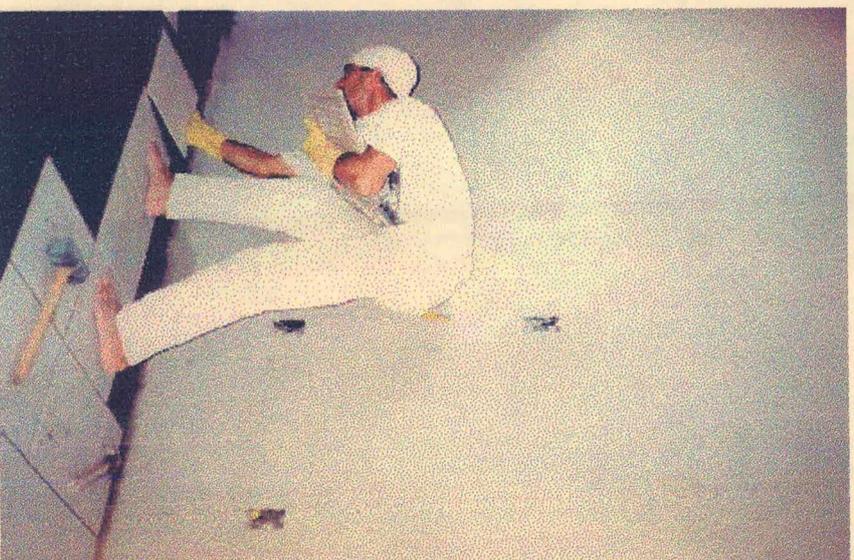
A disposição de peças sobre o piso previamente regularizado
